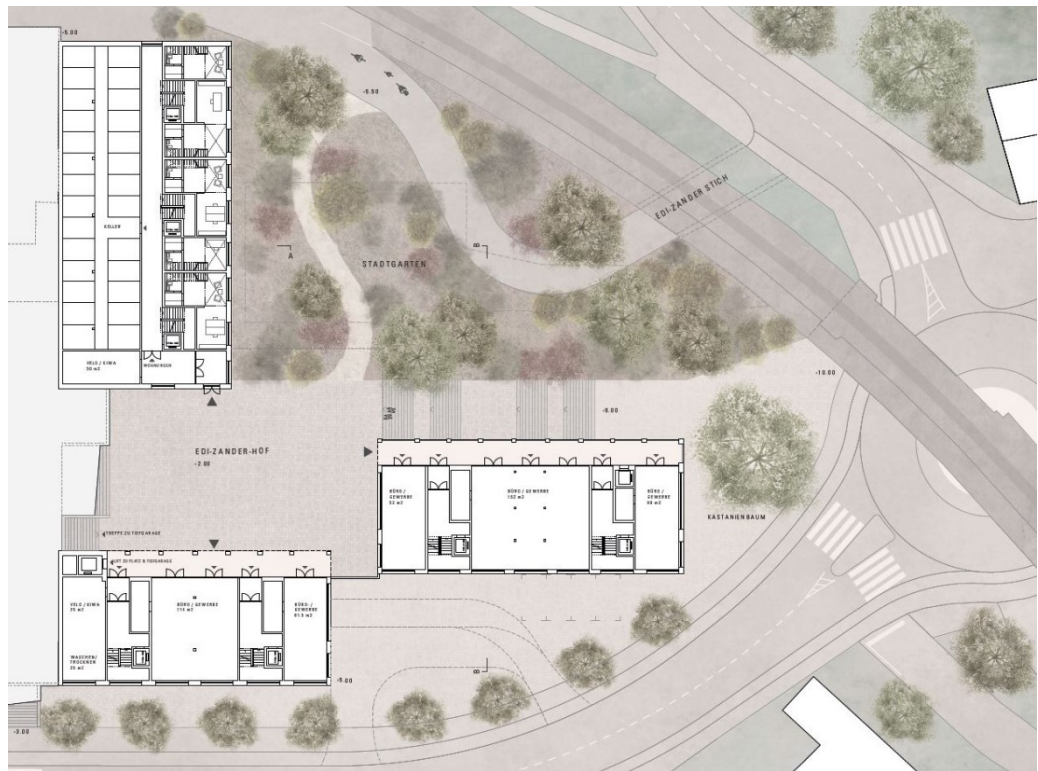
Grundriss EG (Hofgeschoss)
